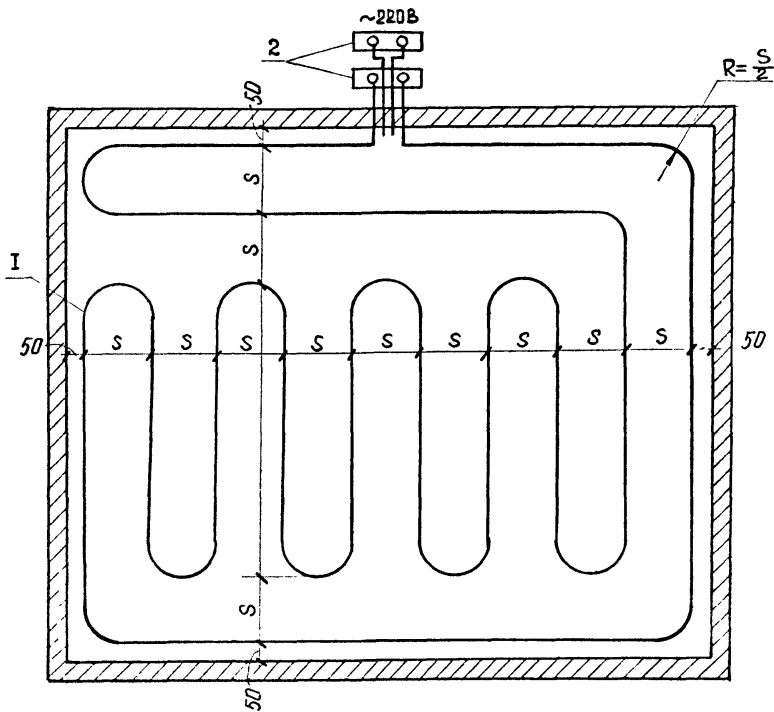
Схема раскладки двухжильного греющего кабеля без использования опорных колодок. I – двухжильный греющий кабель; 2 – клеммная коробка
